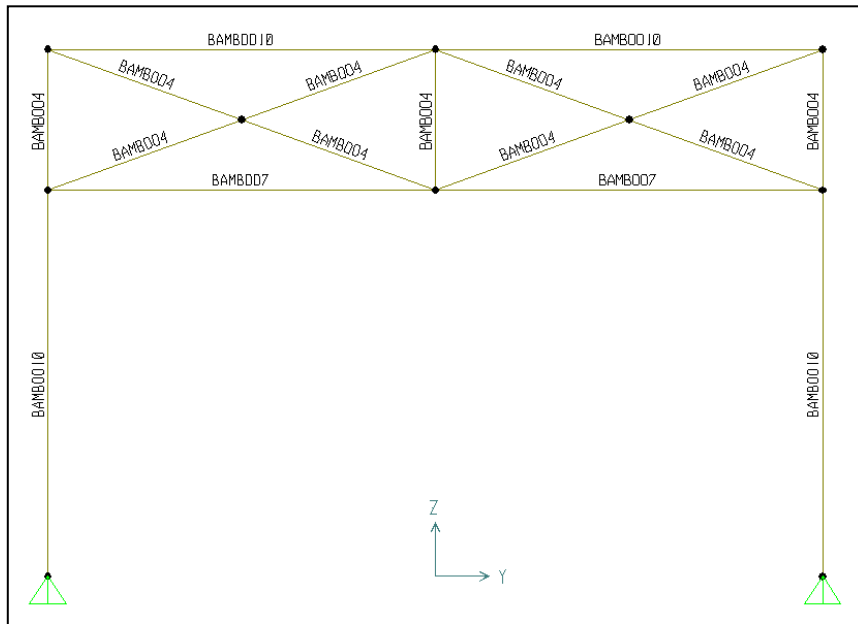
Diámetro de los elementos de la estructura, marco central (plano yz).
